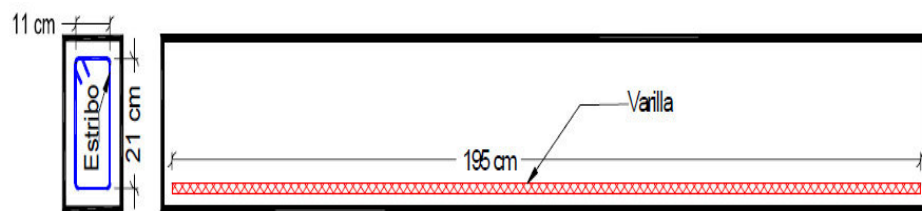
Colocación y detallado del refuerzo longitudinal del arreglo de las vigas.
